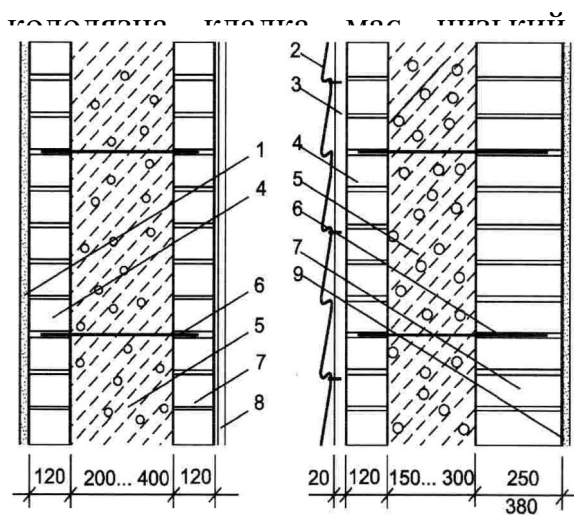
Цегляні стіни з утеплювачем з ніздрюватих або легких бетонів:
